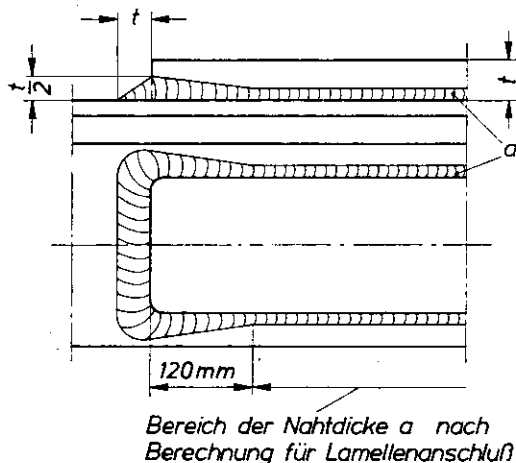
Ausbildung der Schweißnähte an Gurtplattenenden
